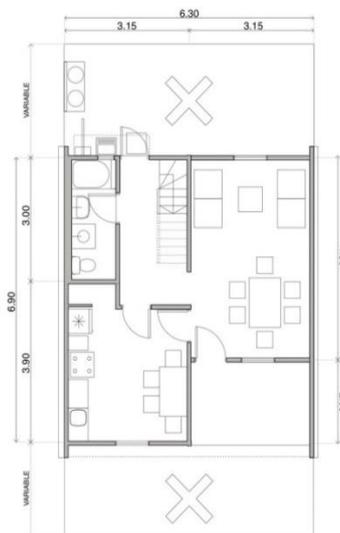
Planta Baixa De Implantação - Habitação Villa Verde / Elemental
